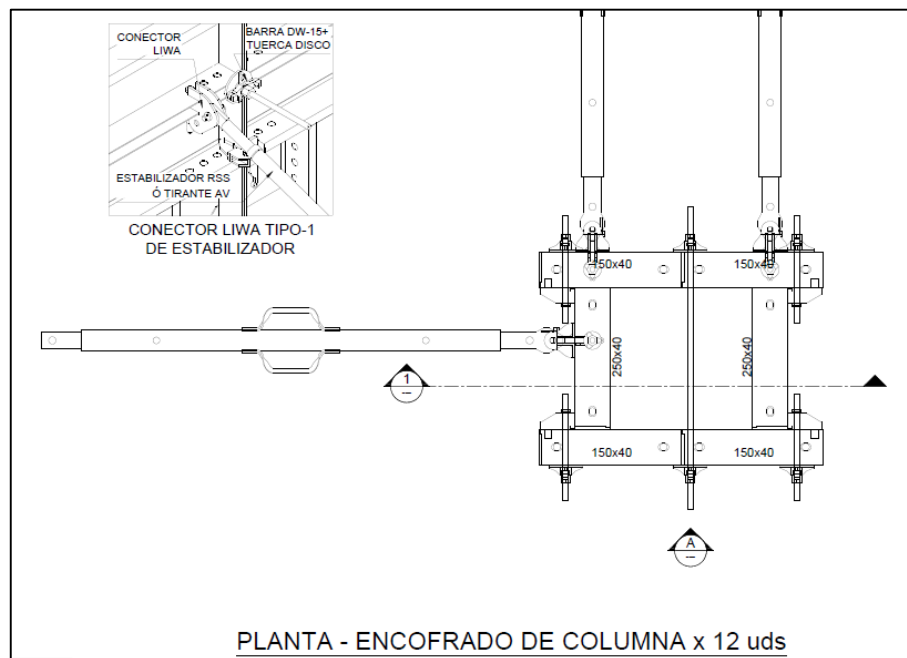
Planta de encofrado de columnas centrales de cisterna de agua tratada.
